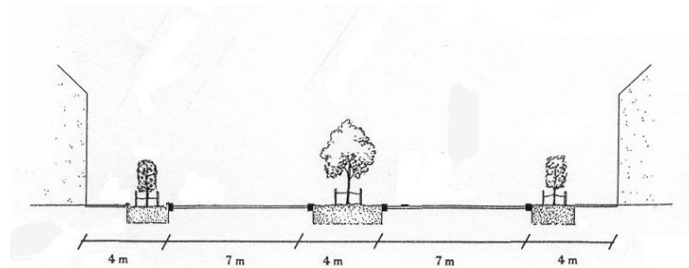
Exemplo de estrutura de plantação em alinhamento em meio urbano (adaptado de Lionnet). Plantação em avenida em corredor verde, com alinhamento de cada lado e separador central.
